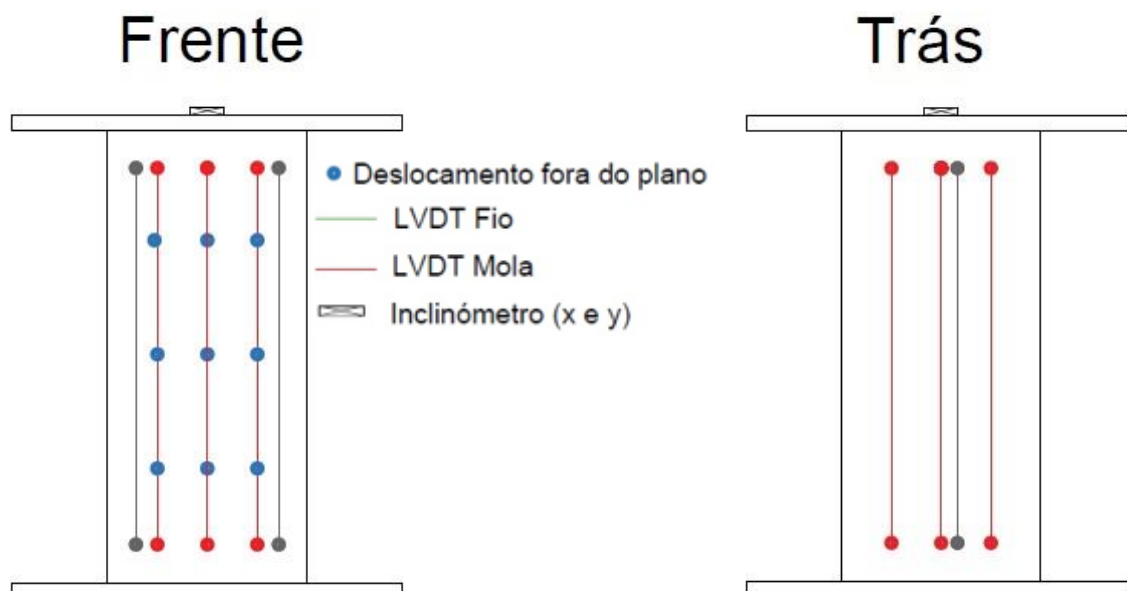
Esquema disposição dos LVDTs na Parede 1, Fase 1
